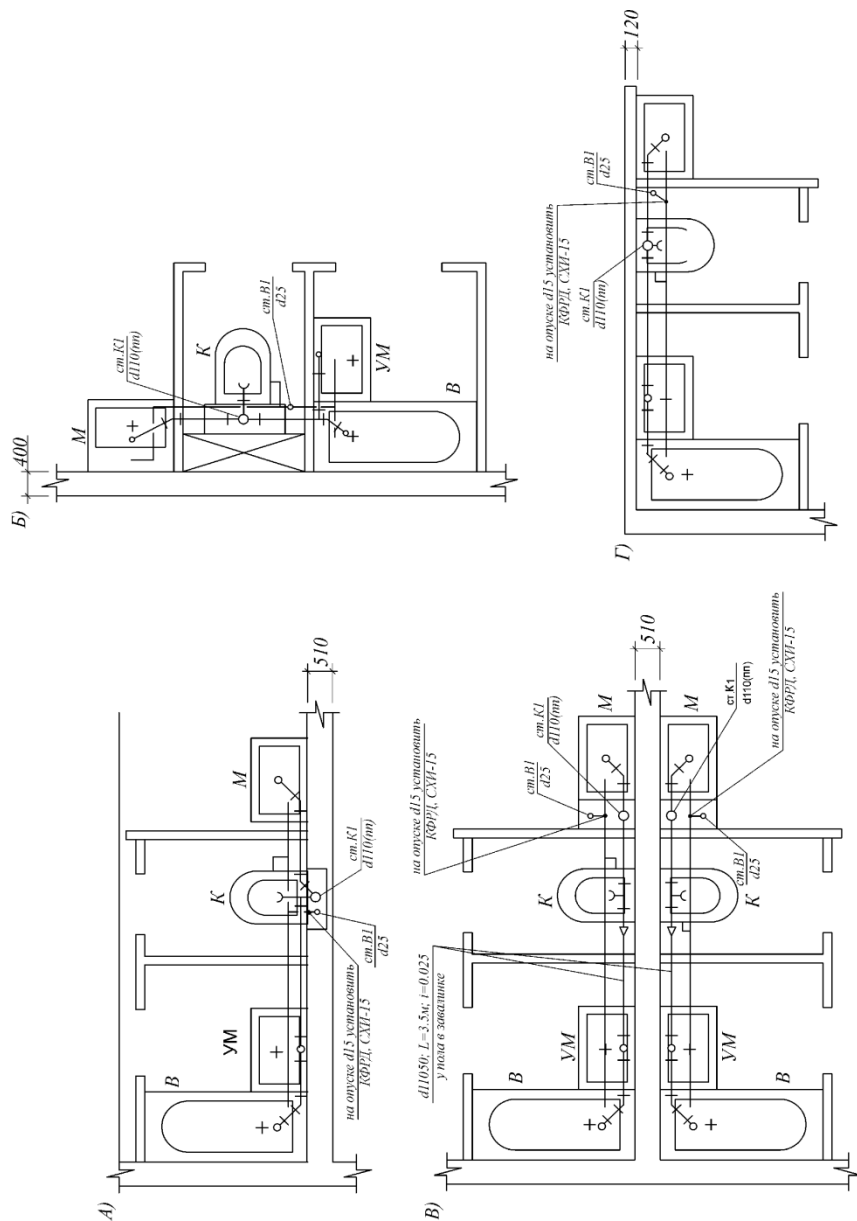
Варианты трассировок систем В1 (водопровод) и К1 (канализация) на плане типового этажа
